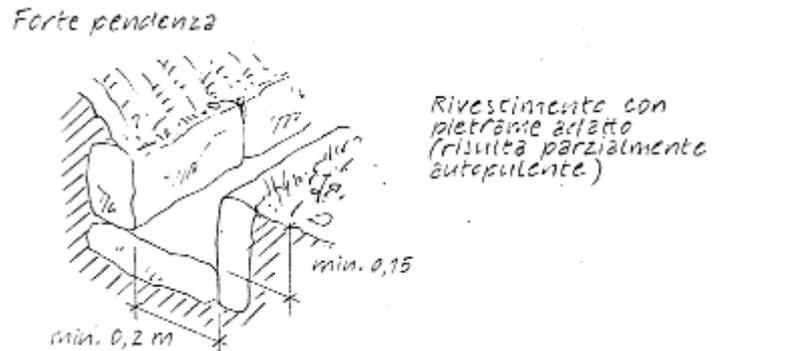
tipologico di canaletta in pietra, particolare 1
